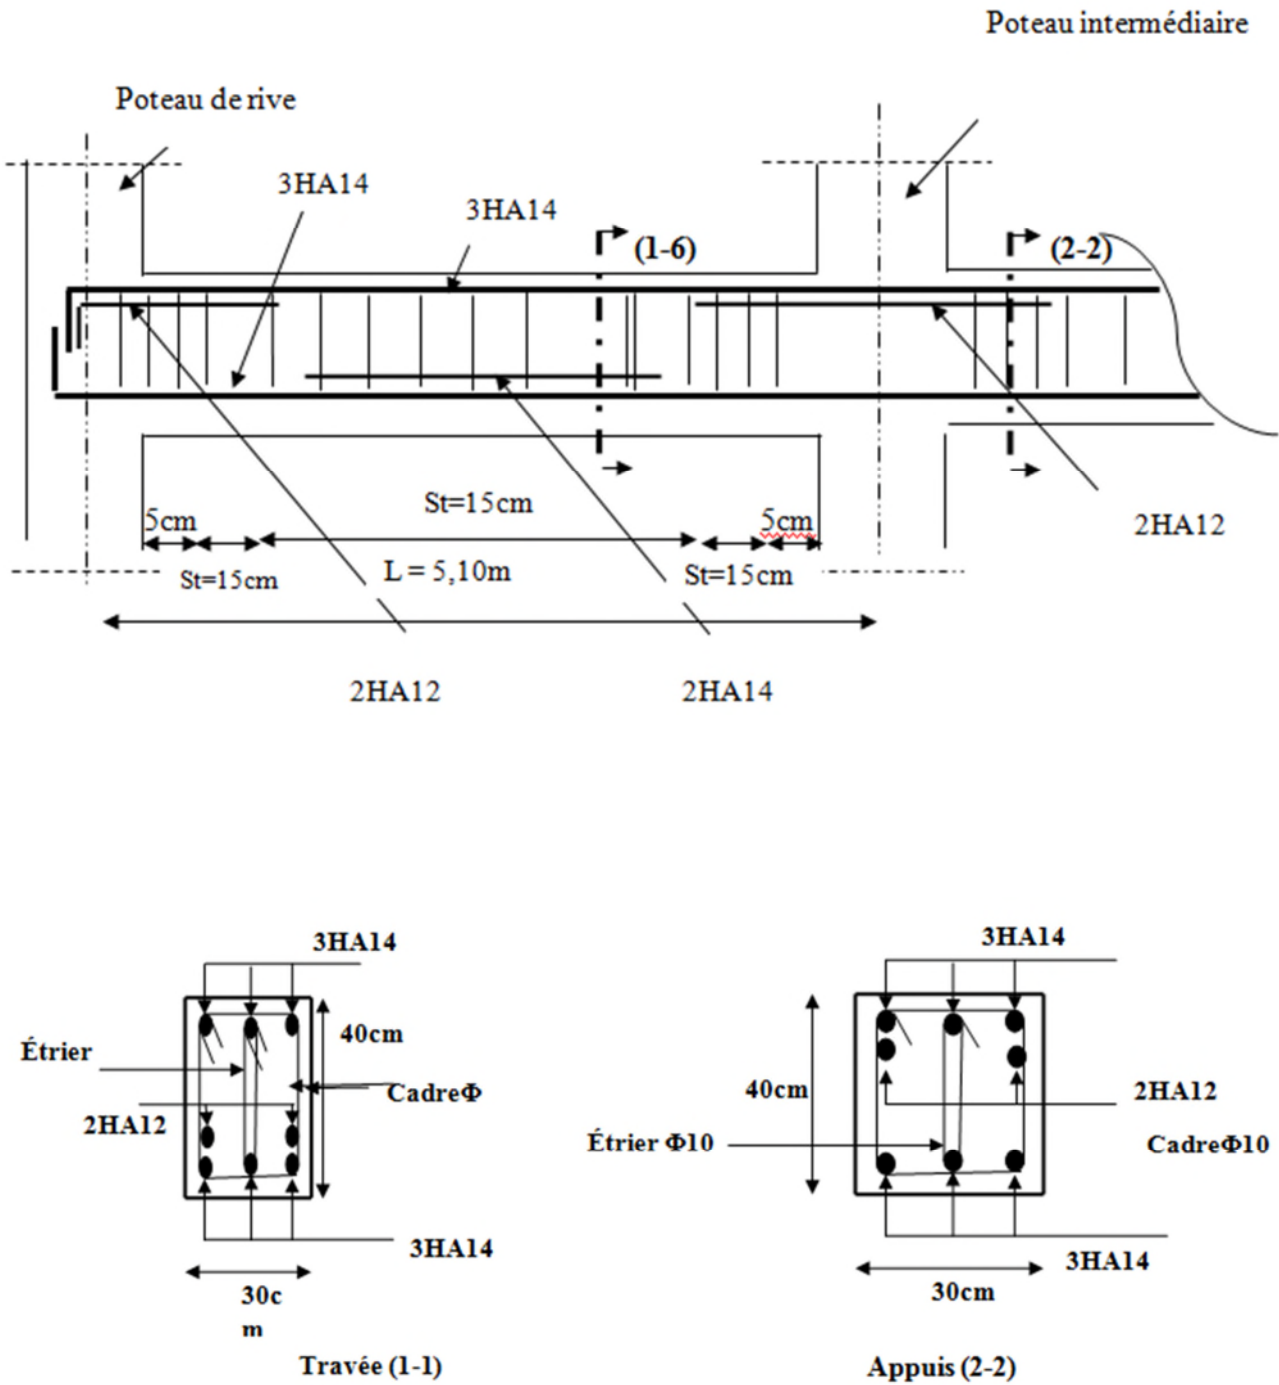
Schéma de ferrailage de la poutre secondaire (30*45) du 2^{ème} au 9^{ème} étage
